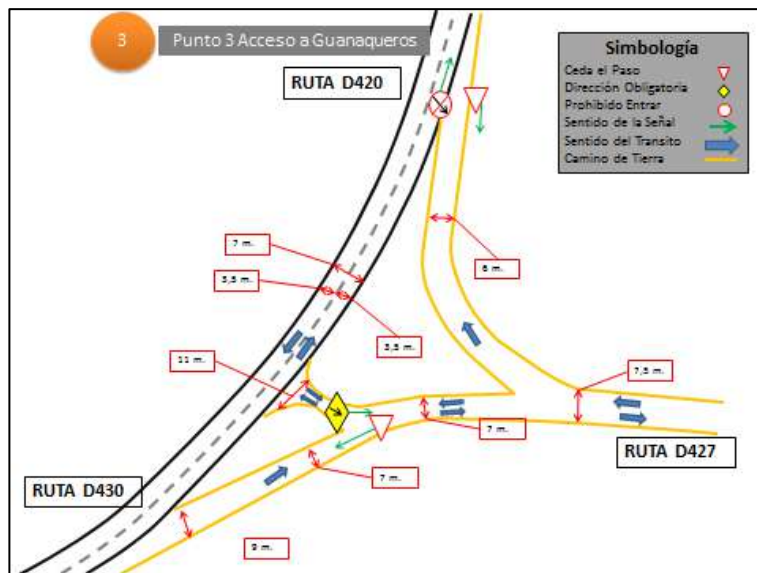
Intersección del punto 3 – Acceso Sur a Guanaqueros y Norte a Tongoy. Fuente: PRC
